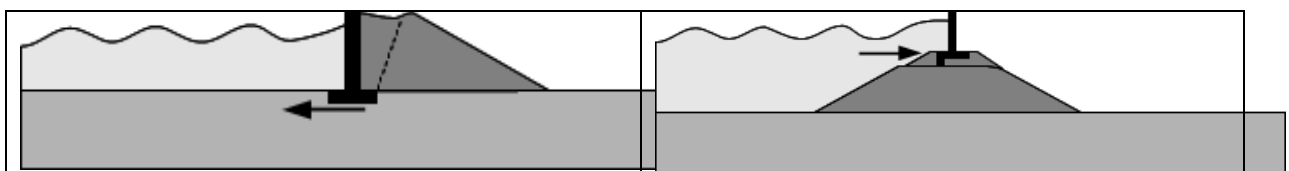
Glissements sur la base d'ouvrages rigides (Traduit et adapté de l'ILH)
